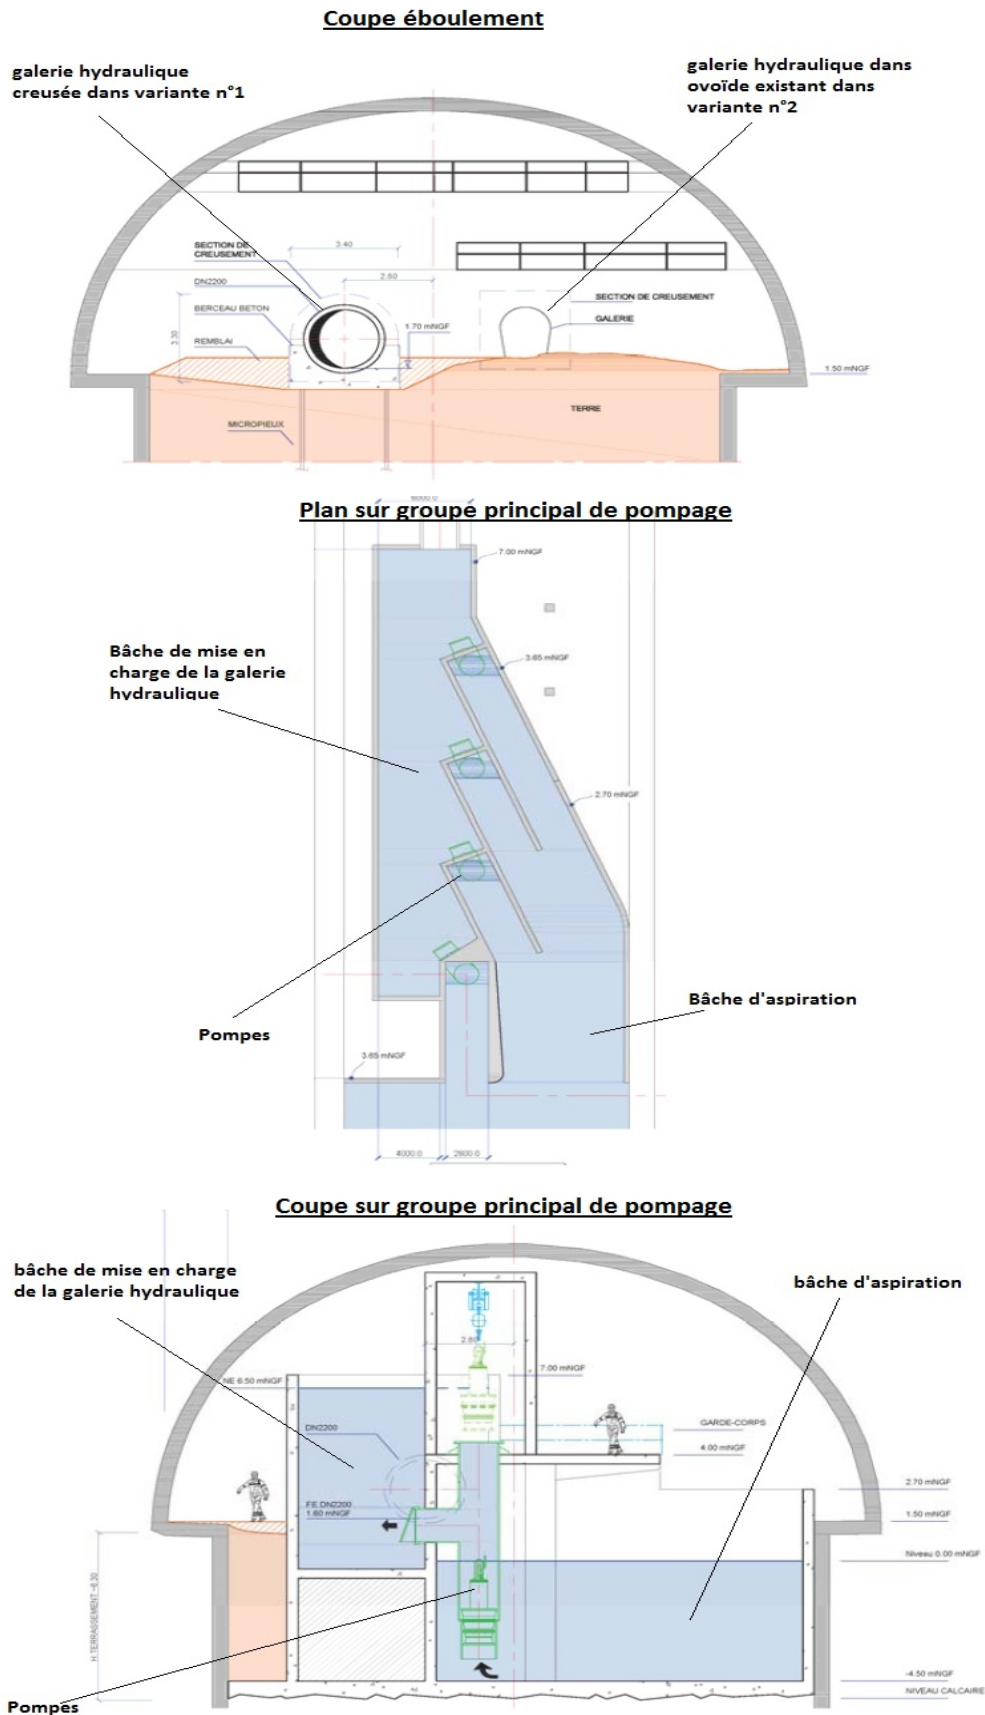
Plan et coupes des variantes 1 et 2 d'ouvrage hydraulique
